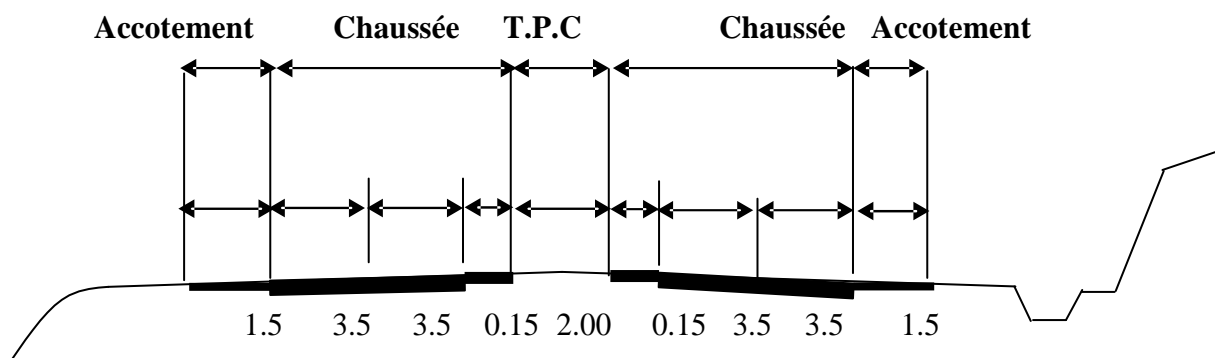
Schéma explicatif d'une Coupe transversale de la chaussée
